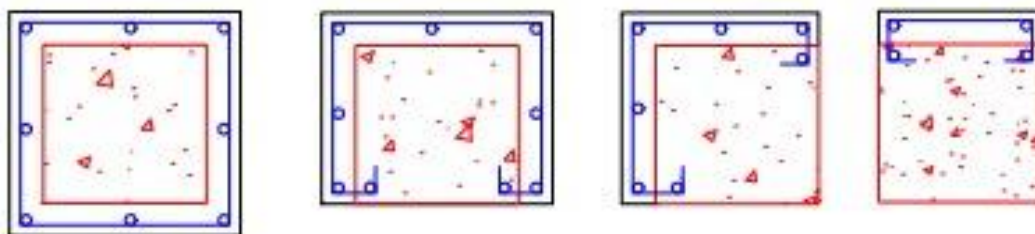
Configuração de reforço de pilares por aumento de seção total ou parcial e novas armaduras longitudinais e transversais, com a área vermelha sendo o pilar antigo e a indicado em azul as novas armaduras da nova área a ser implementada no reforço.
